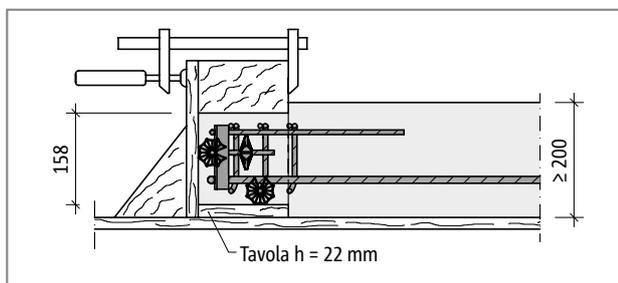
Schöck Tronsole® tipo Z, esecuzione di una mensola d'appoggio sul pianerottolo prefabbricato; spessore del pianerottolo $h \geq 200$ mm
